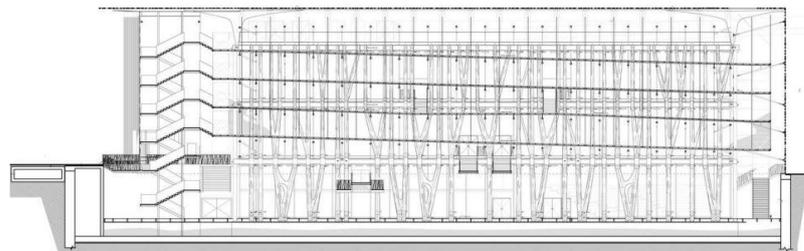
représente une coupe sur passerelles périphérique en façade sud-ouest.
